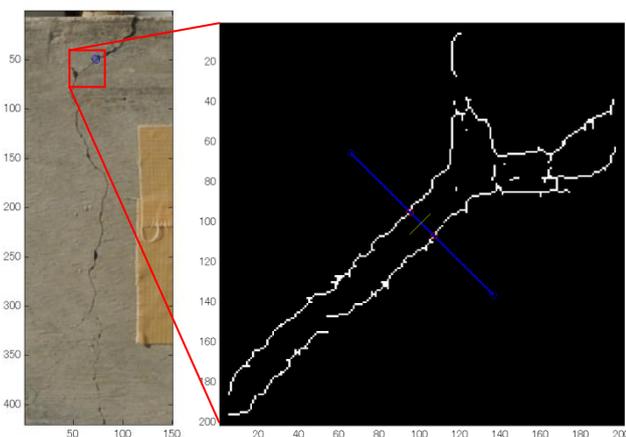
5m先におけるコンクリートひび割れ箇所を計測
